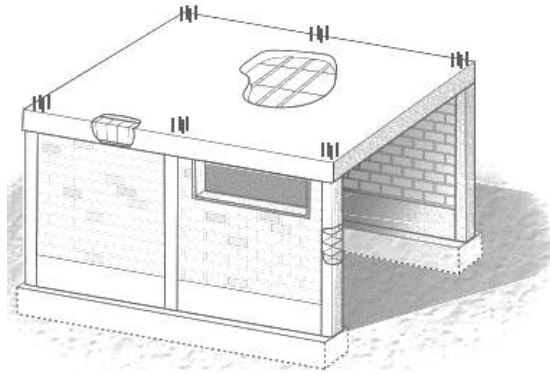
Vista isométrico de una albañilería confinada (Manual de Construcción para Maestros, 2010, p.6)
